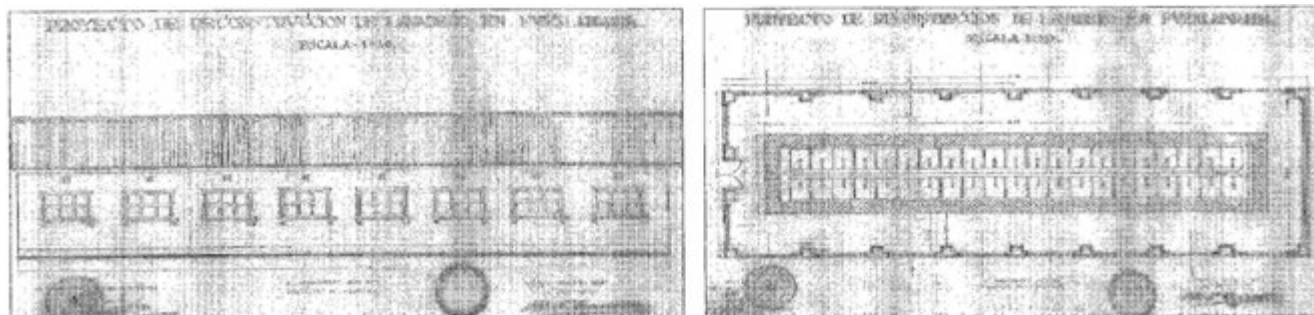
Alzado y planta del proyecto de reconstrucción del lavadero de Fuenlabrada de Rita Fernández Queimadelos. Fuente: AA.VV. 2004, 407.
